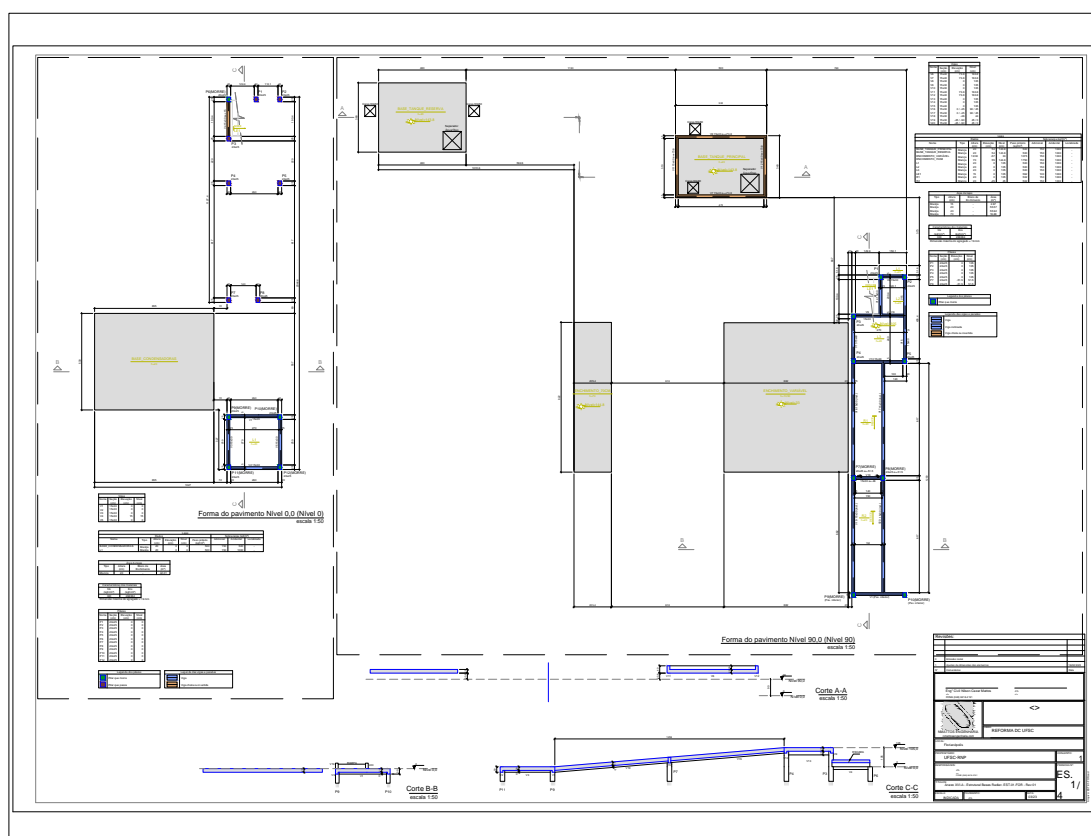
Anexo XVI-A - Estrutural Bases Radier- EST-01-FOR - Rev 01-Layout1
